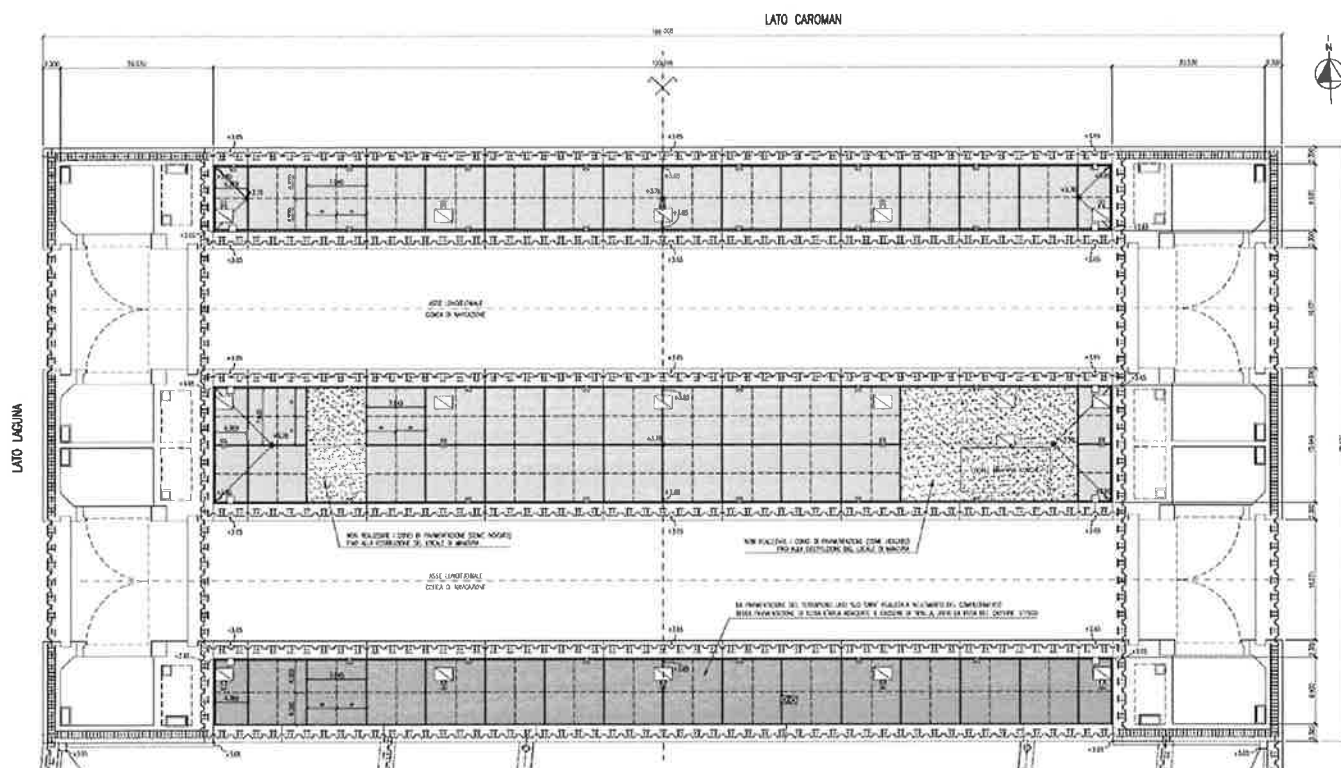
CONCHE DI CHIOGGIA – PLANIMETRIA DELLE CONCHE – STATO DI FATTO AL TERMINE DELLA WBS CH.E1.10
